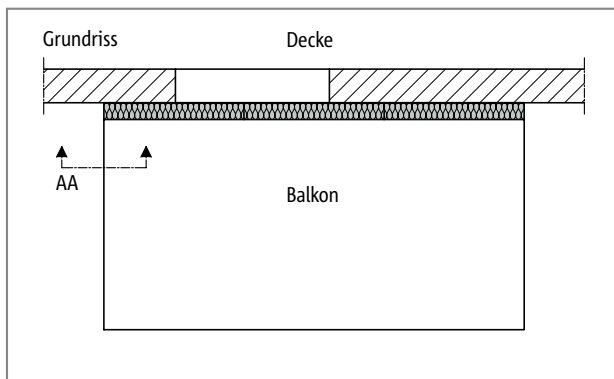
Schöck Isokorb® CXT Typ K: Darstellung der Lage von dem Schnitt A-A
